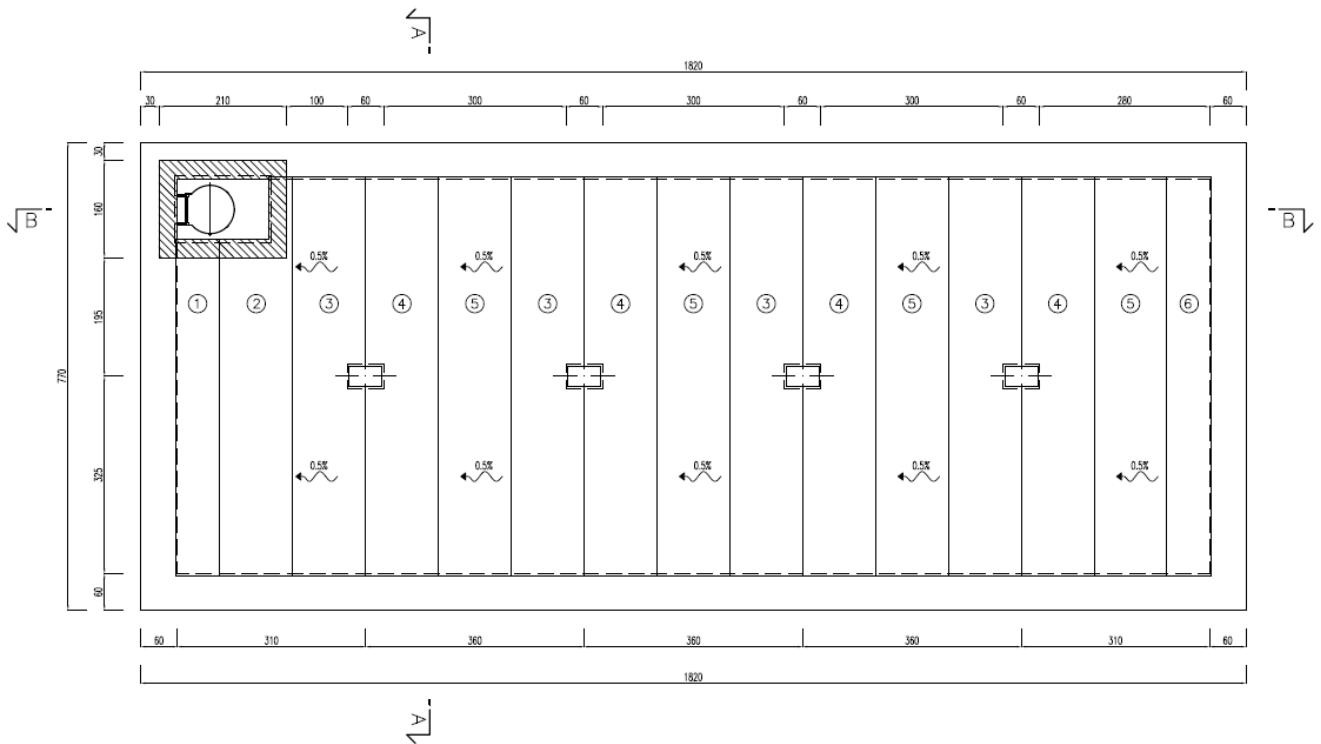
Plattengrundriss mit Balken und Predalles-Plattenkonstruktion
